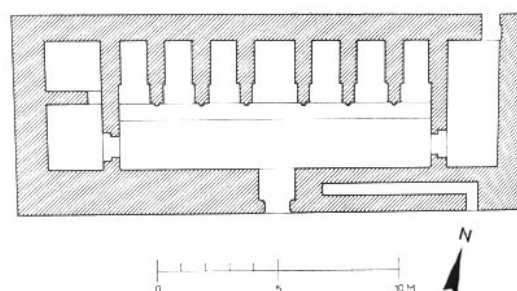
Grundriss Heiligtum/Kasr el-Sagha
